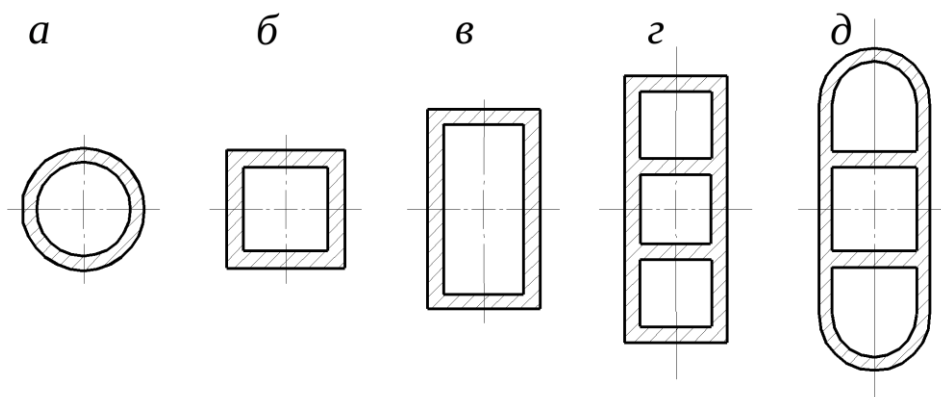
Форми опускних колодязів у плані: а – круглий; б – квадратна; в – прямокутний; г - прямокутний з двома паралельними перегородками; д - овальний з двома перегородками
